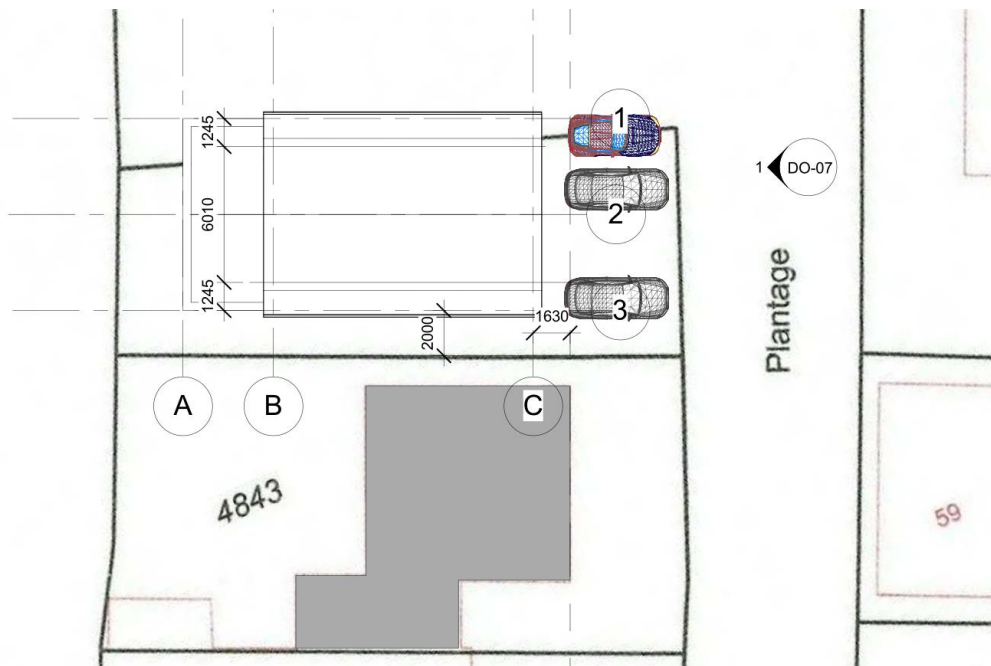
ontwerptekening van de uitbreidingen bij Plantage 50. (Plantage-geest-DO gekregen van opdrachtgever in april 2016).
